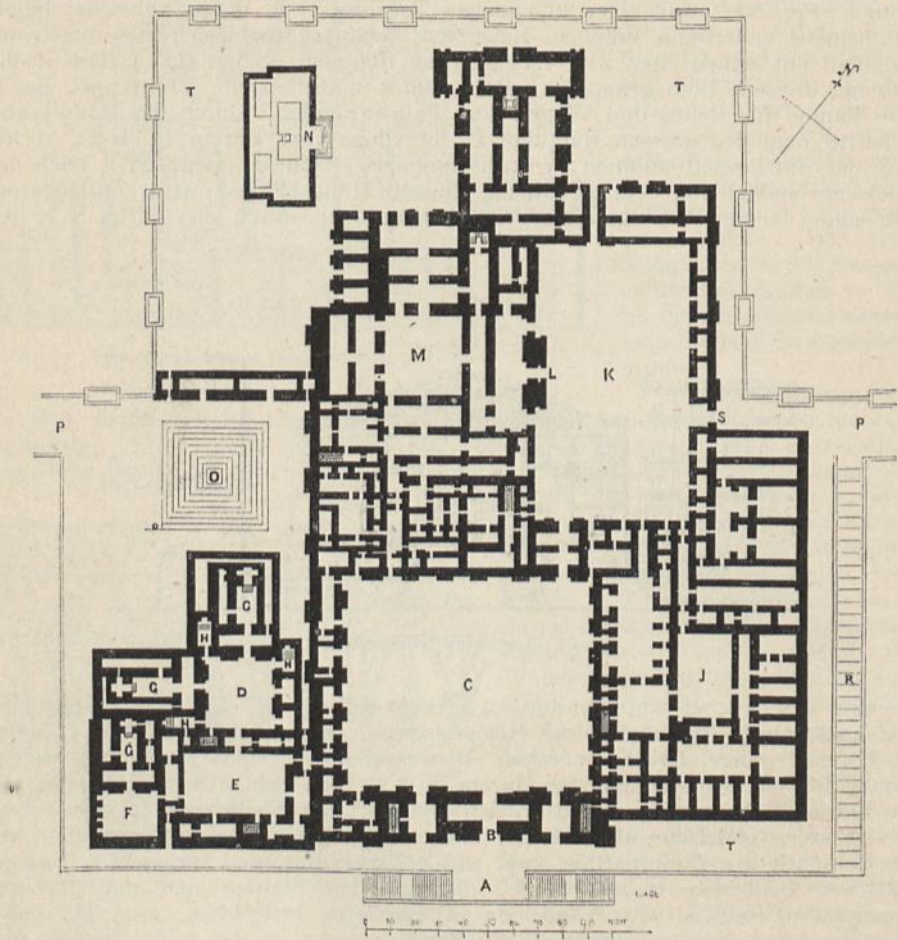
Grundriss des Palastes von Khorsabad.
